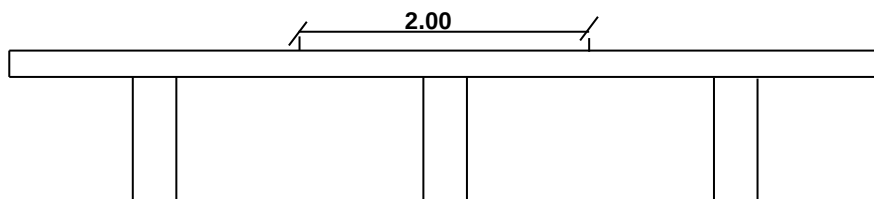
Longitud aferente de losa que actúa sobre la viga interior.
